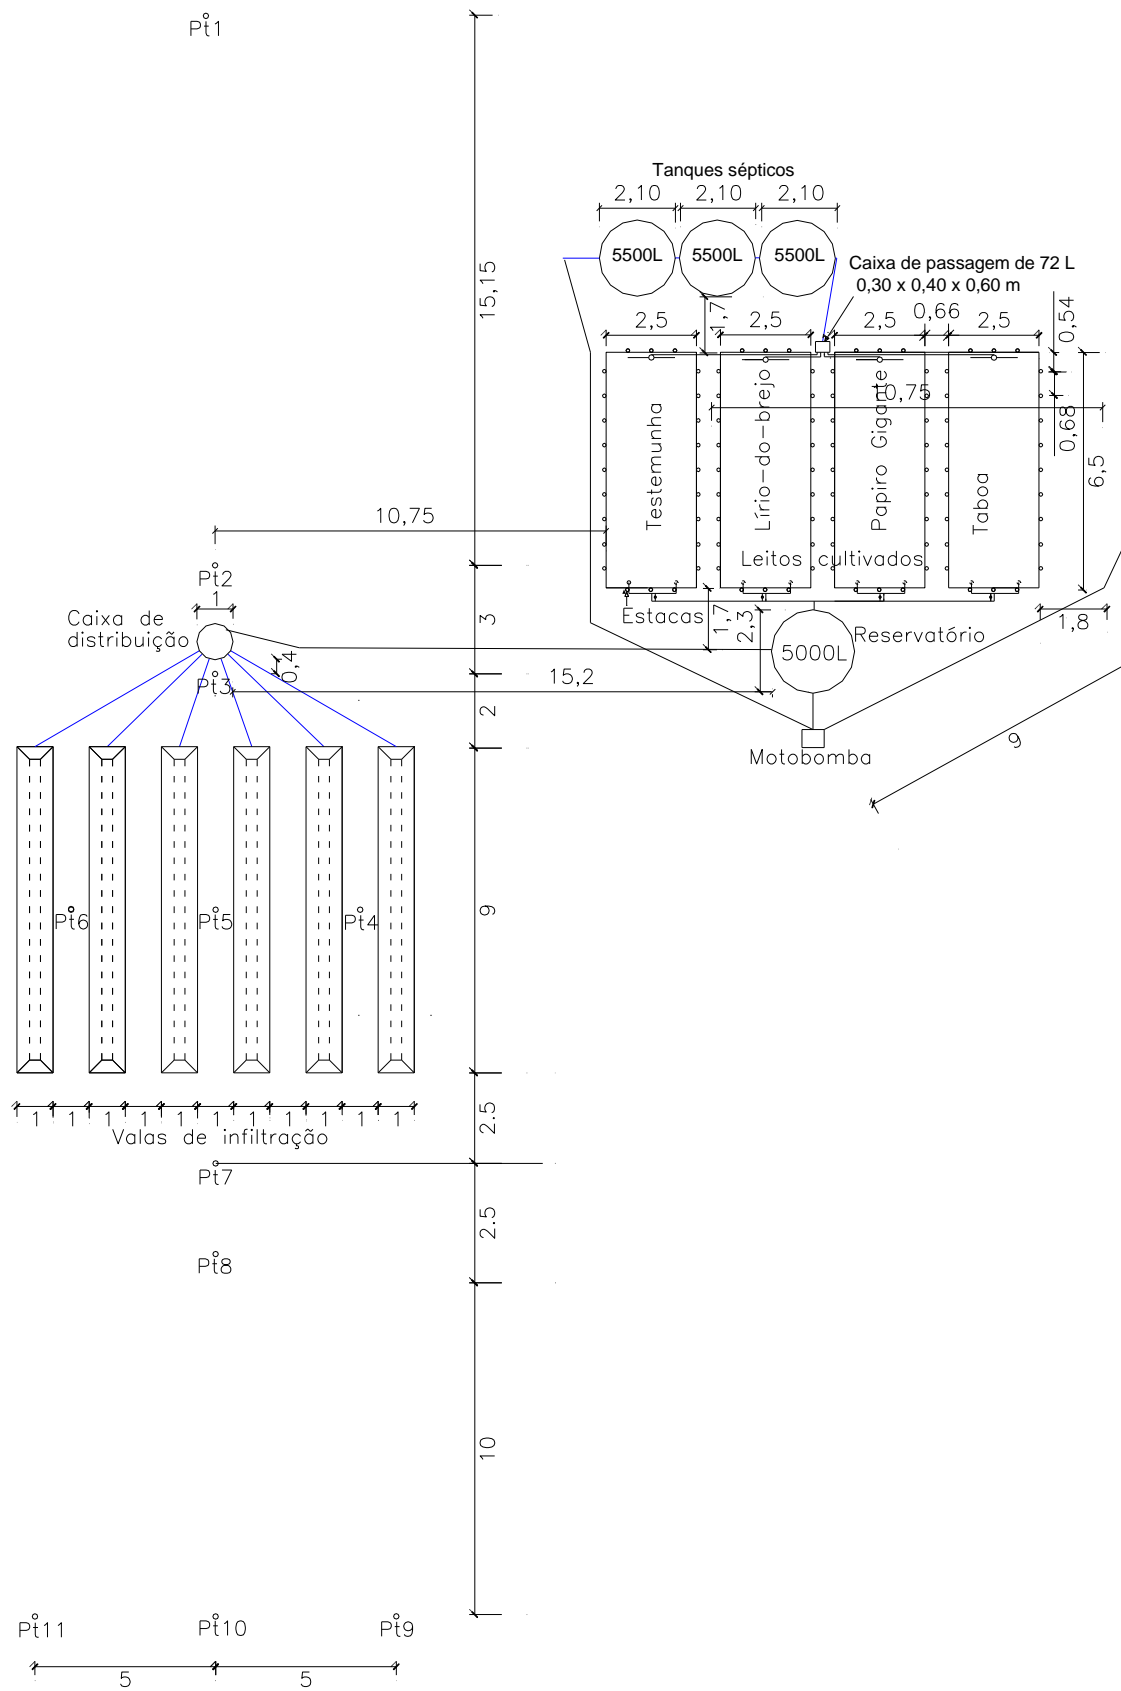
Planta baixa da estação de tratamento do esgoto (ETE/FAL/UnB).
